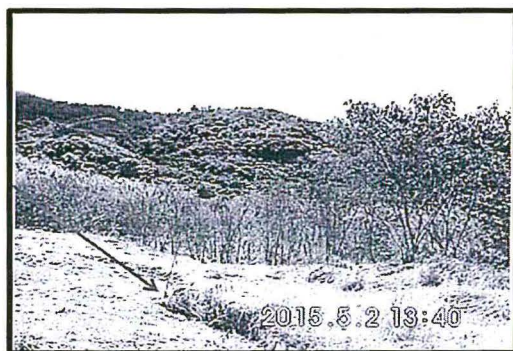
Detalle del área afectada sobre el DDV. Vegetación quemada por el derrame de LGN. Grandes grietas longitudinales y escarpes evidencian la omisión de obras de control de erosión y medidas geotécnicas para estabilizar los taludes y laderas en el DDV. Coordenada UTM sistema WGS84: 0656041E, 8570198N
